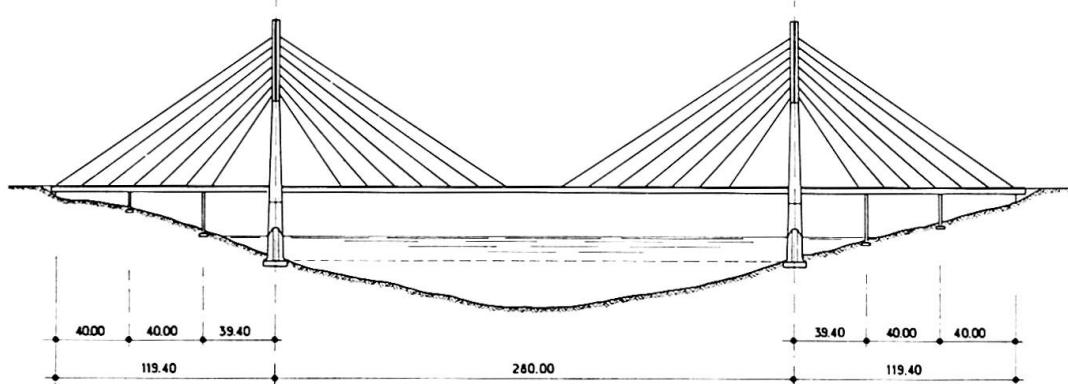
Coupe longitudinale du pont sur le Rio CARONI (portée : 280 m)
